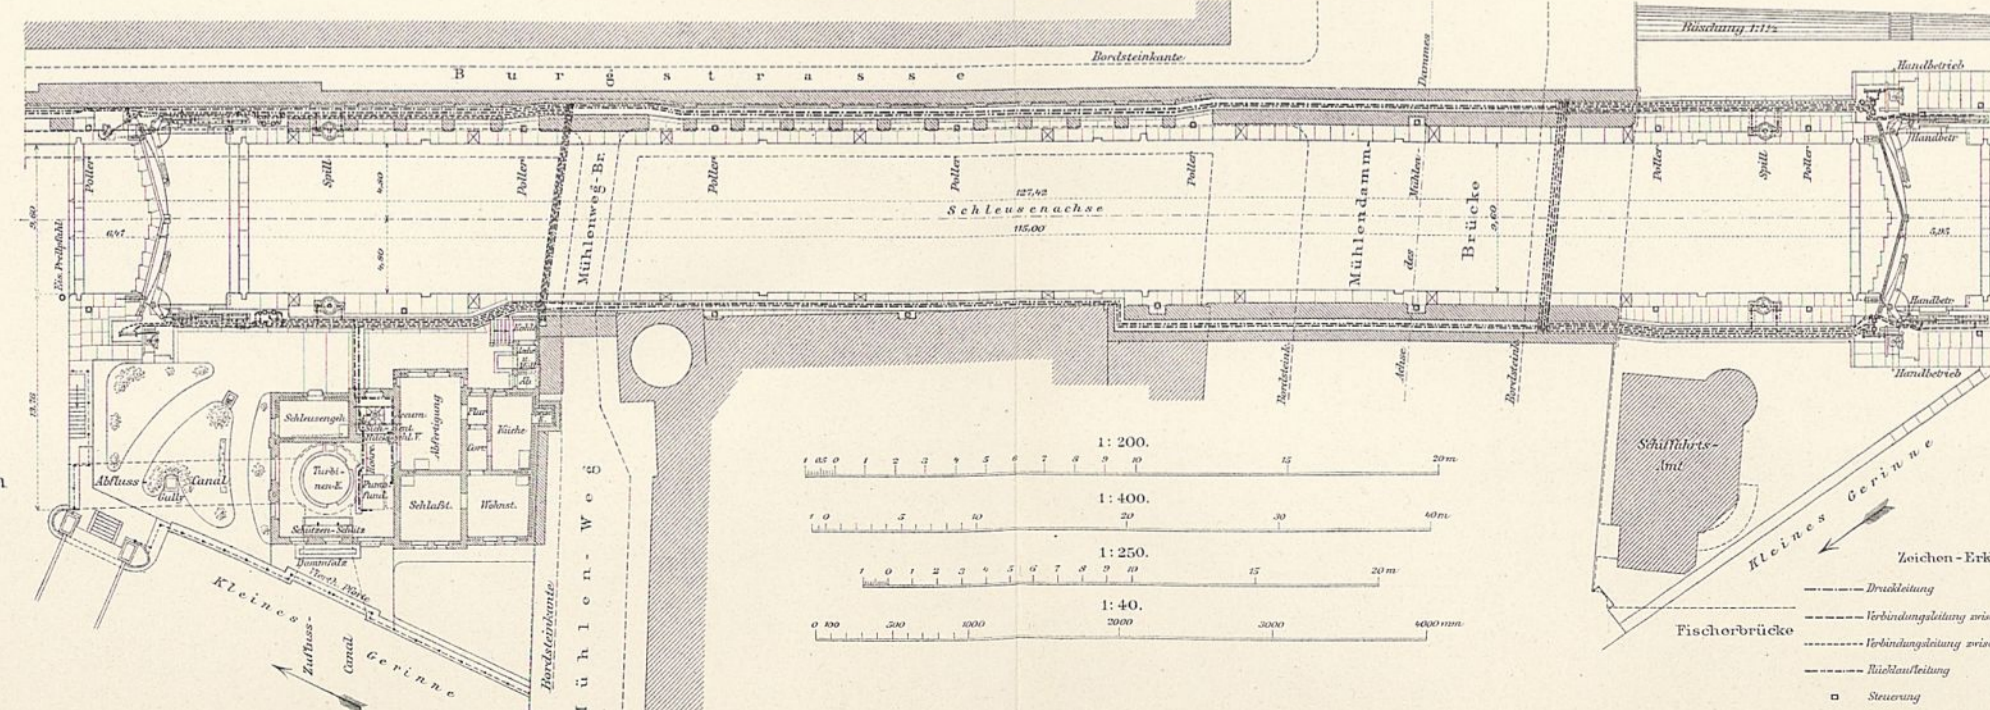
Grundriss der Schleuse in Deckplattenhöhe Ord. 33.0. 1: 400.
